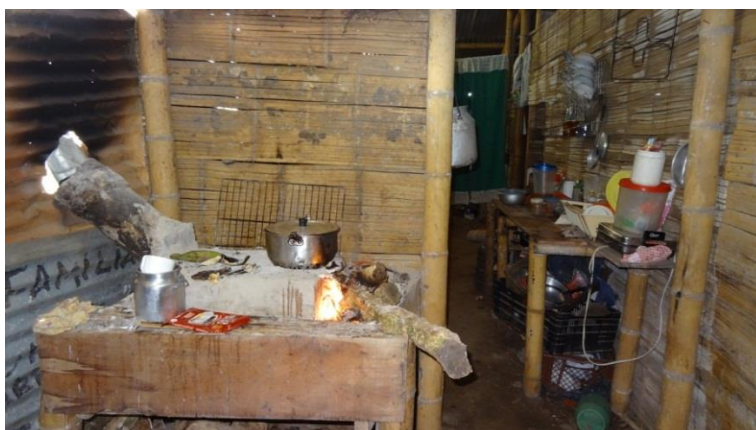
Cocina vivienda espontánea. Vista 3. Fogón de leña, pared de esterilla/zinc. 2017
